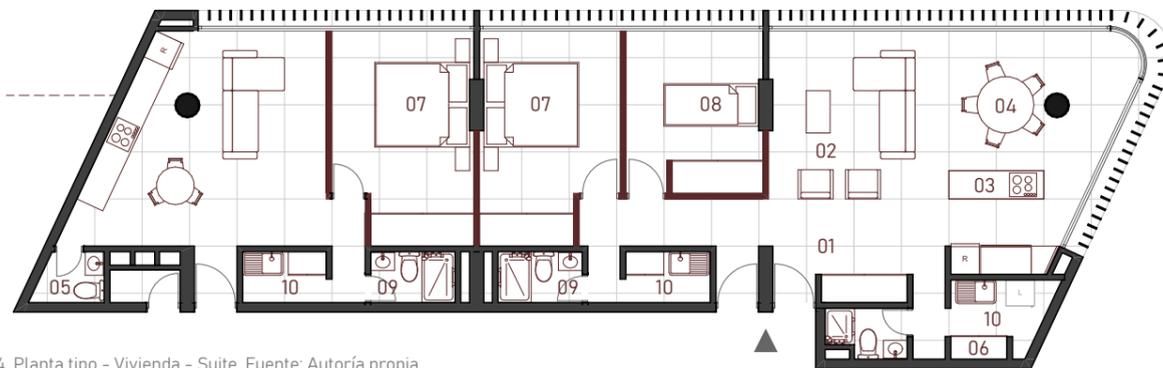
Planta tipo - Vivienda - Suite. Fuente: Autoría propia.
